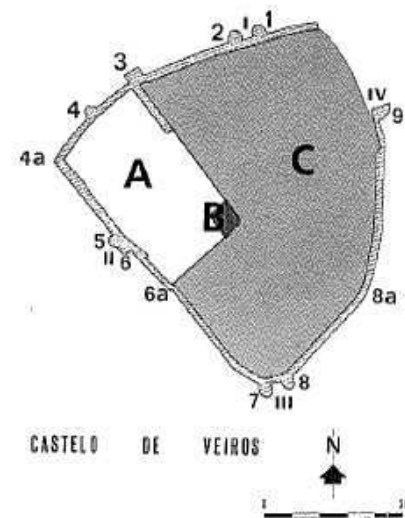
Planta Esquemática do Castelo de Veiros.
